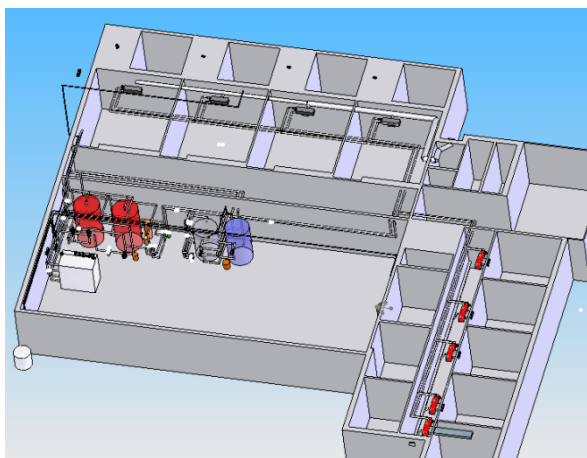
Esquema de la planta baja del edificio CIESOL con la red de los fan-coils (fuente A. Estrada).
